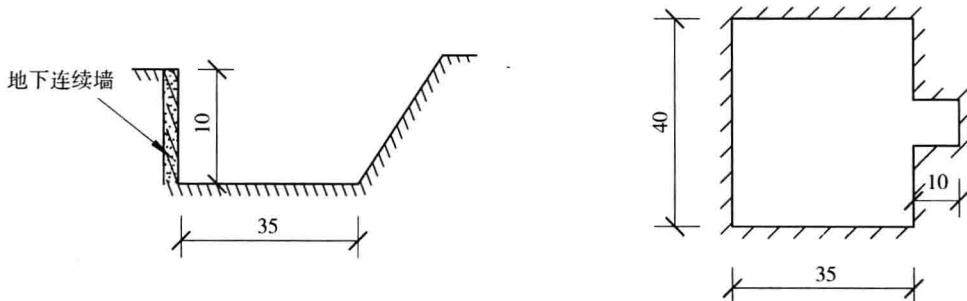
左图为围护基坑纵断面图, 右图为平面图 (单位: m)
